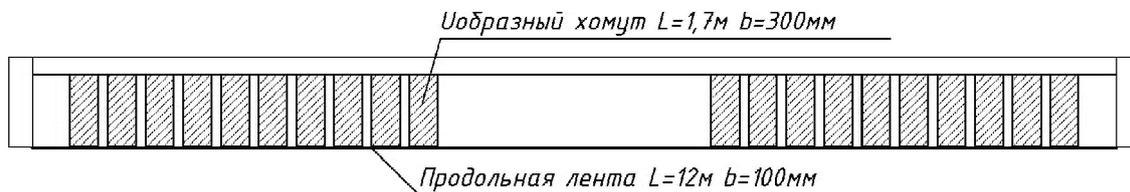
Общая схема усиленной конструкции углеволокном.
